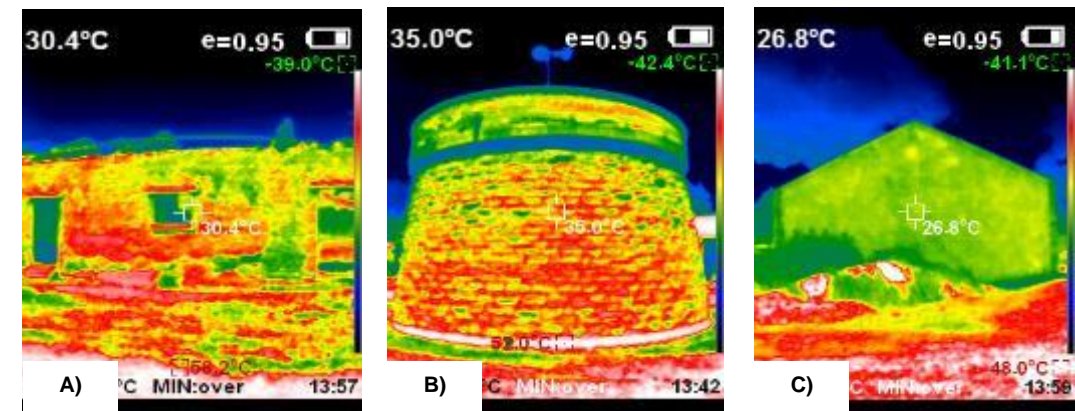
Absorción de calor en los edificios de la Estación de Boca del Monte. A) Fachada sur de la Casa de sección. B) Fachada sur de la Base del tanque de agua. C) Fachada poniente de la Casa de sección. (2021). [Fotografía]. Fuente: Equipo de Trabajo de la Maestría de Conservación del Patrimonio Edificado de la FABUAP.
